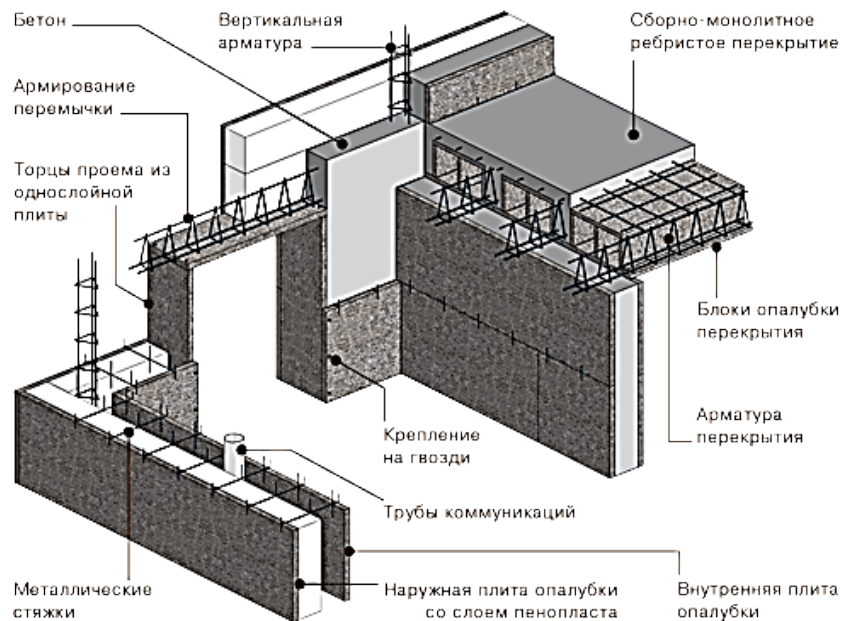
Конструктивна схема опалубки плит з цементно-стружкових плит: 1 – металеві стяжки; 2 – торці прорізу з одношарової плити; 3 – армування перемички; 4 – бетон; 5 – вертикальна арматура; 6 – збірно-монолітне ребристе перекриття; 7 – блоки опалубки перекриття; 8 – арматура перекриття; 9 – кріплення на цвях; 10 – труби комунікацій; 11 – внутрішня плита опалубки; 12 – зовнішня плита опалубки з шаром пінопласту
